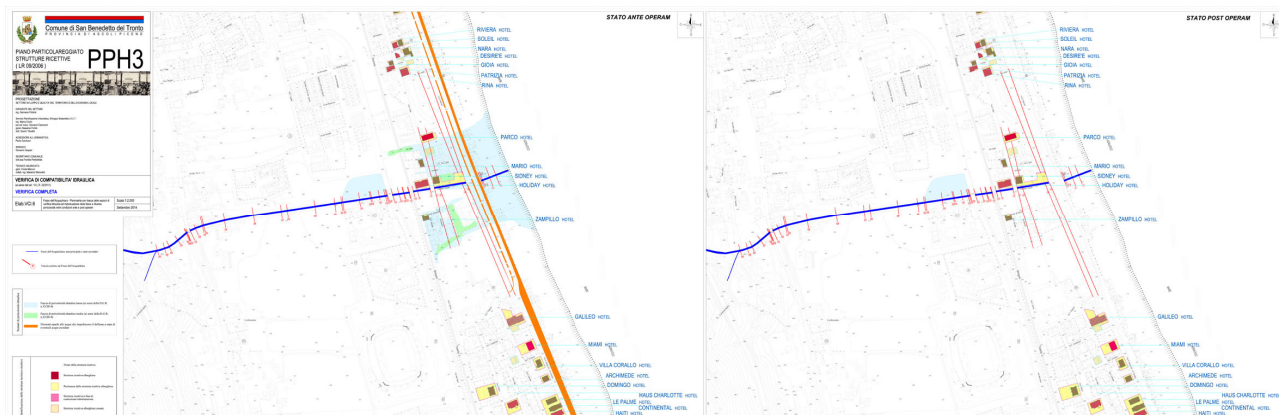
"Fosso dell'Acquachiara: Planimetria con tracce delle sezioni di verifica idraulica e individuazione delle fasce a diversa pericolosità idraulica, ante e post operam"(Fonte VCI – Verifica Completa PPH3)
